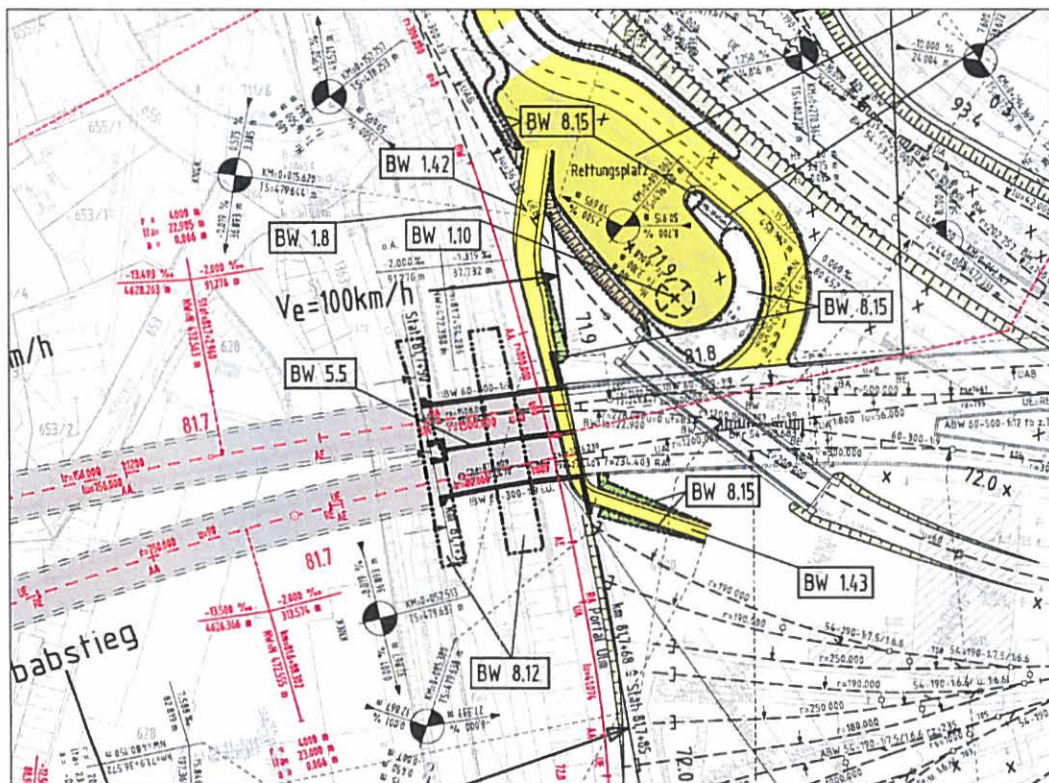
Lageplan (Ausschnitt) Portal Ulm [BGS06b]
